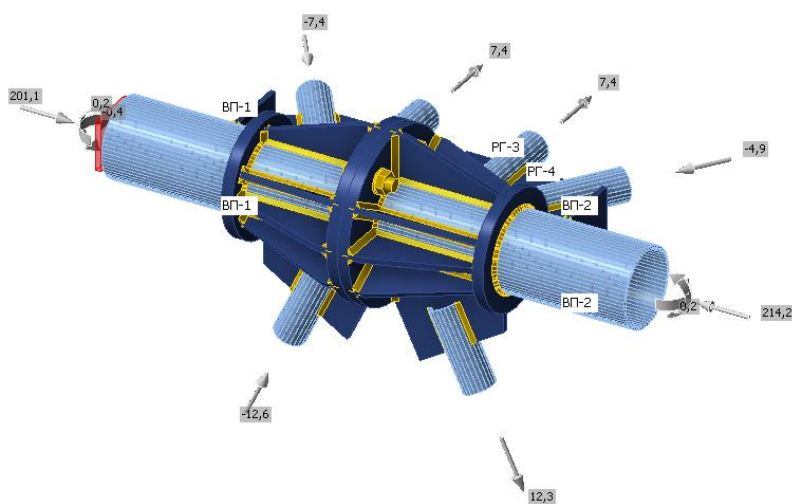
Монтажний стик верхнього поясу просторового блоку ферми
